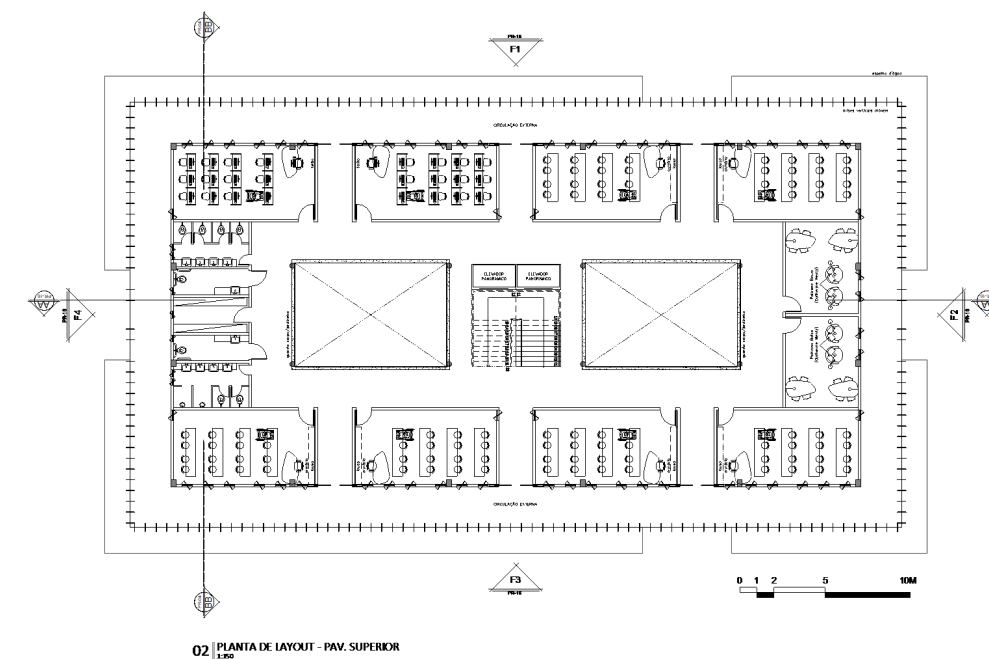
Planta baixa pavimento superior do bloco pedagógico). Elaborada pela autora, 2022.
